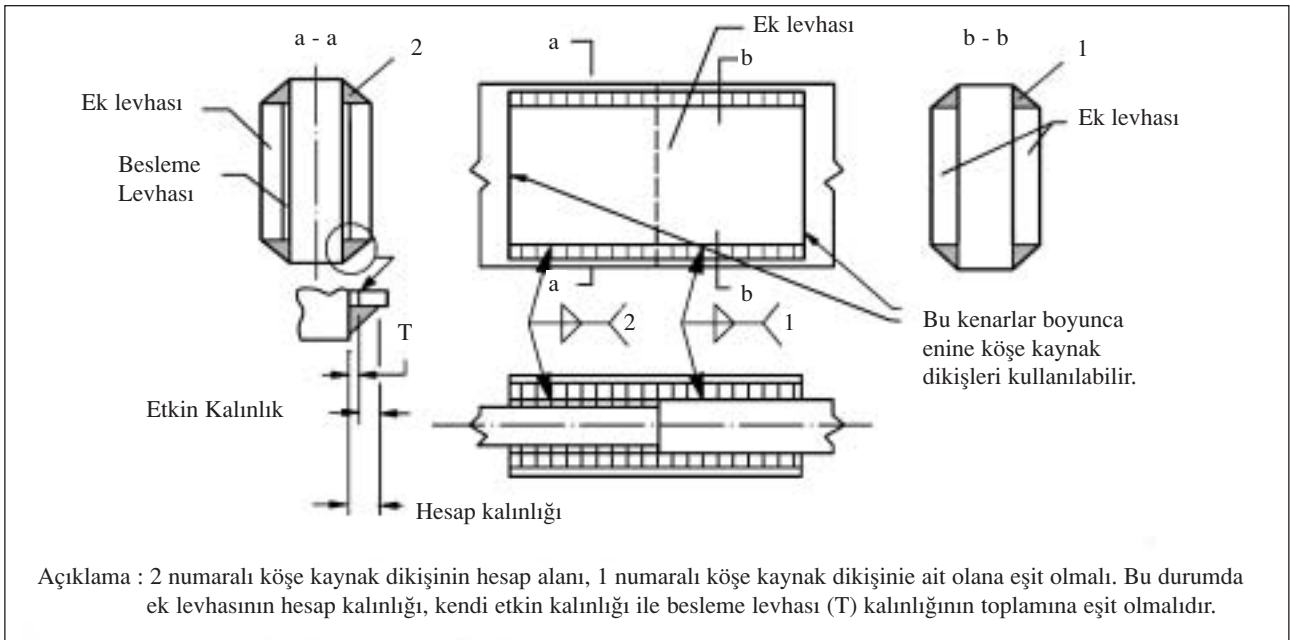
Boyuna ve enine köşe kaynak dikişlerinin uçları
